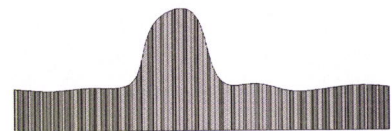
Corte da terra empilhada de forma a conferir um aspecto plano.
